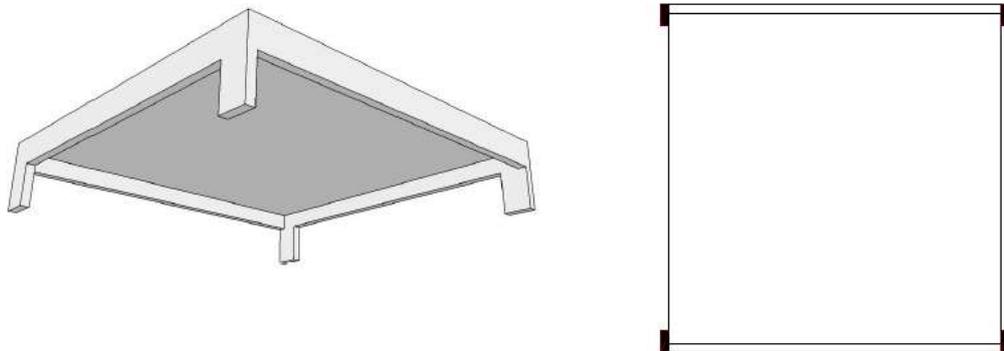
Modelo 01 com Lajes Maciças (Edificação Térrea)
